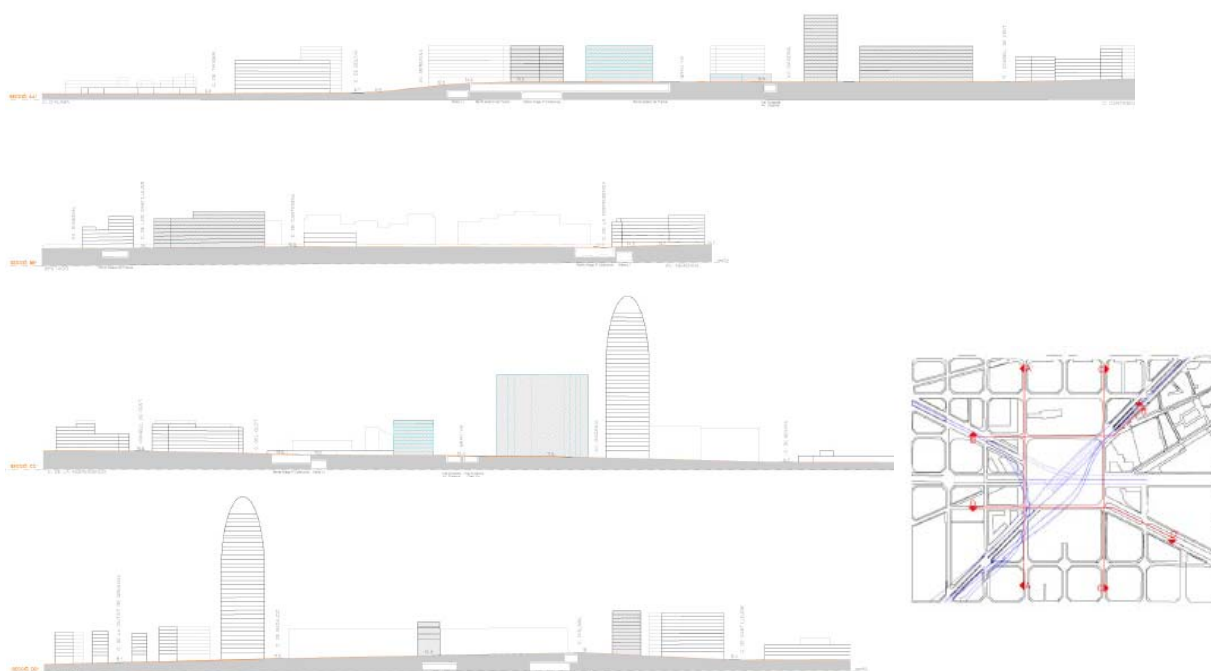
Alzados de las diferentes fachadas edificatorias de la nueva Plaza de las Glorias
